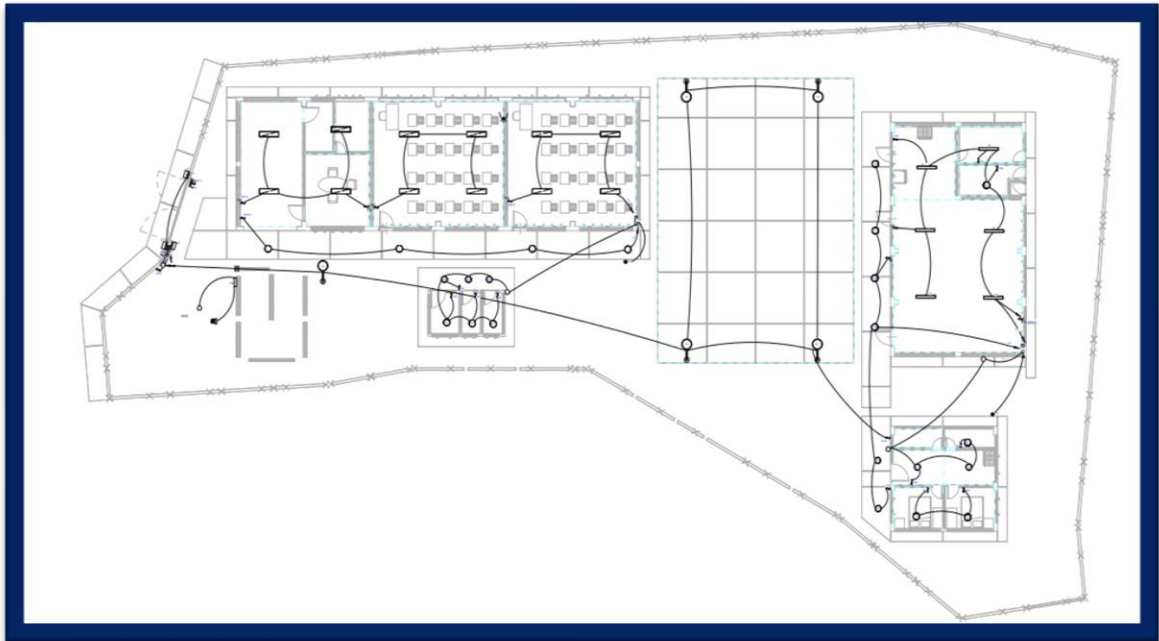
Instalaciones eléctricas - alumbrado del proyecto.
